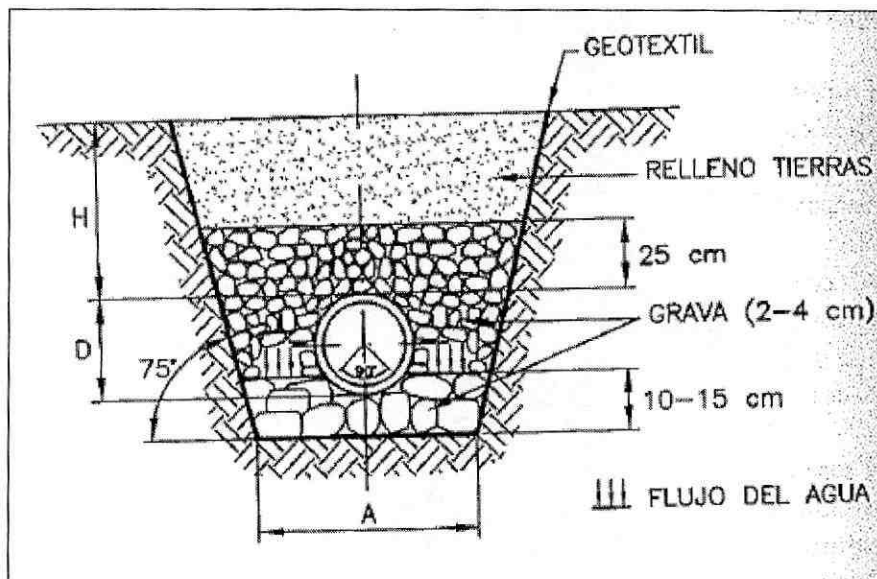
Esquema canaleta de drenaje al pie de la ladera.
